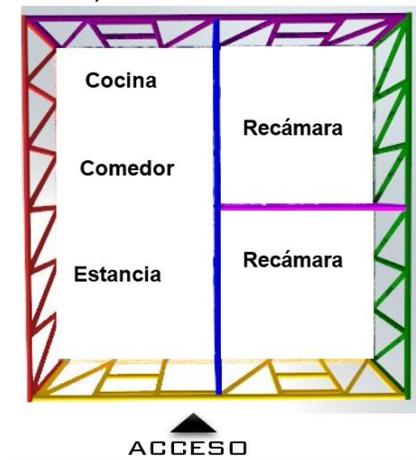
Losa de cimentación vivienda emergente.
